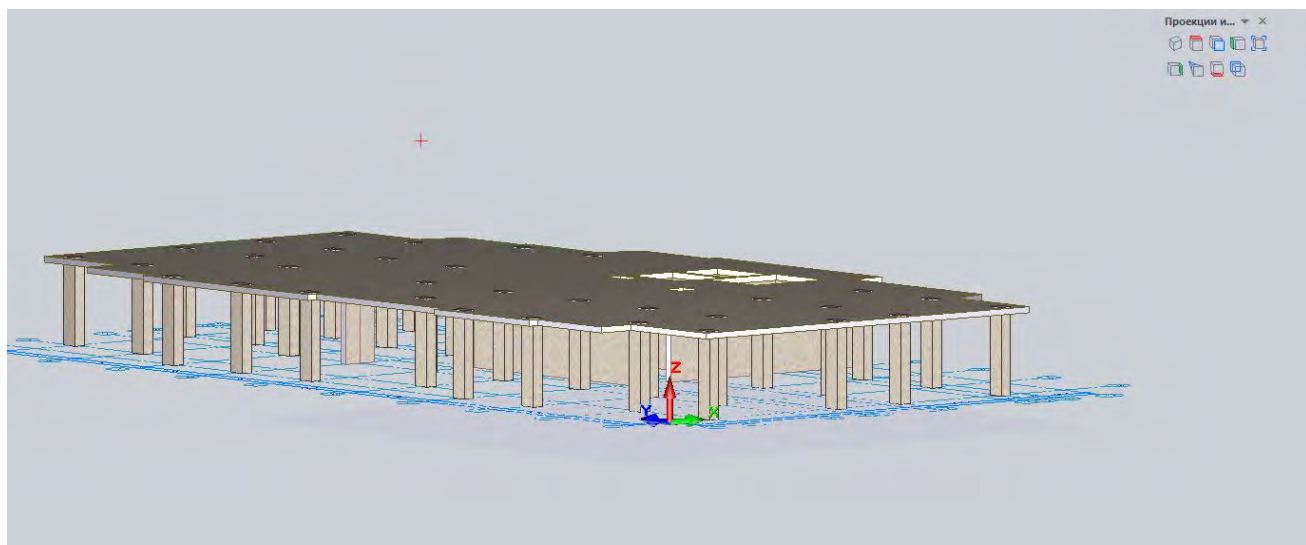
Монолитная плита перекрытия с несущими элементами
